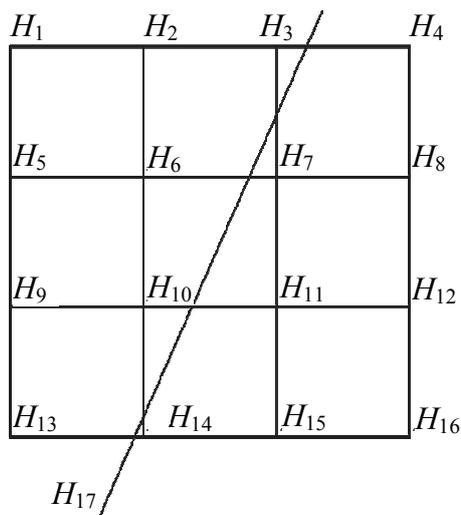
Проектирование горизонтальной площадки с нулевым объемом земляных работ
